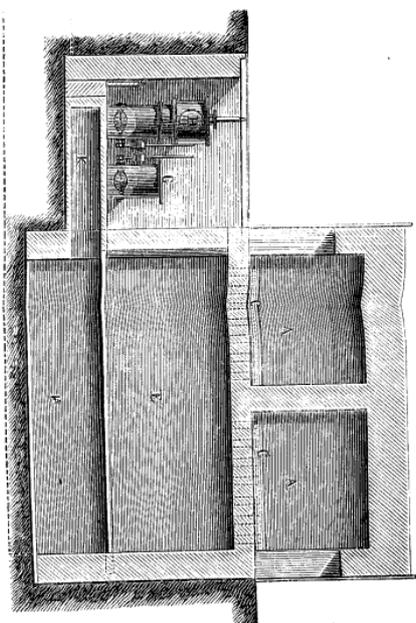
Coupe longitudinale suivant (C) du plan.
